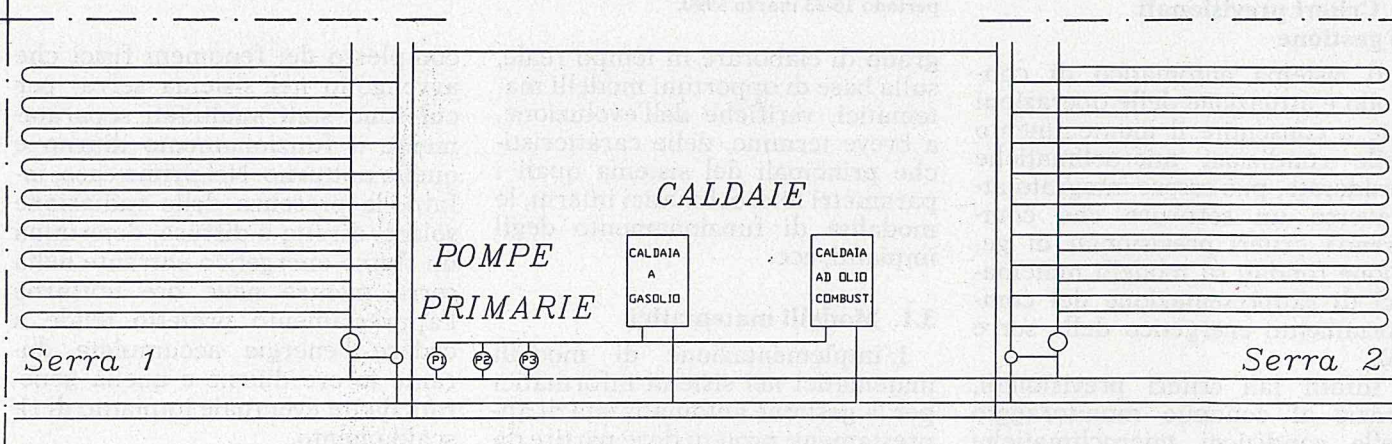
Schema della centrale termica e stralcio dell'impianto di riscaldamento delle serre 1 e 2.
